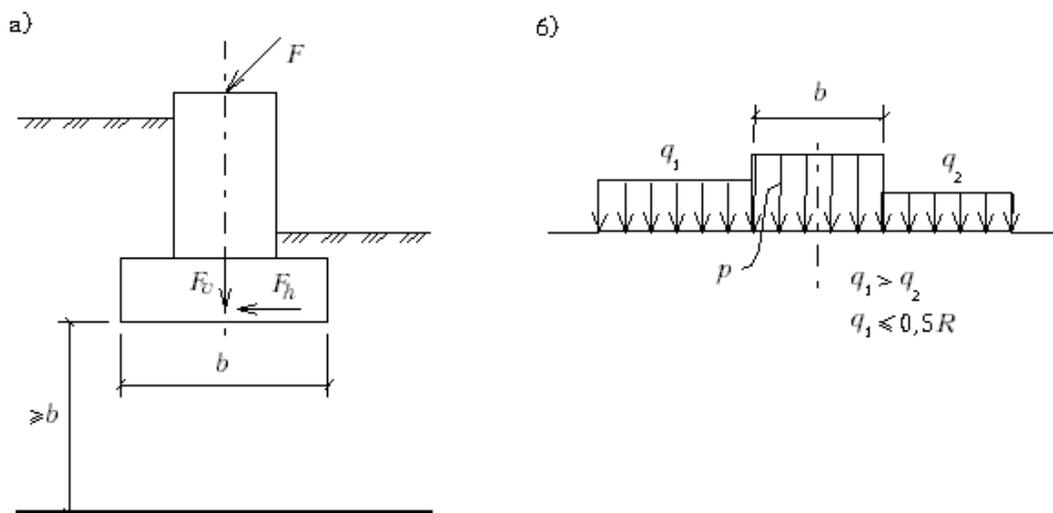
Определение предельного сопротивления грунта основания:
